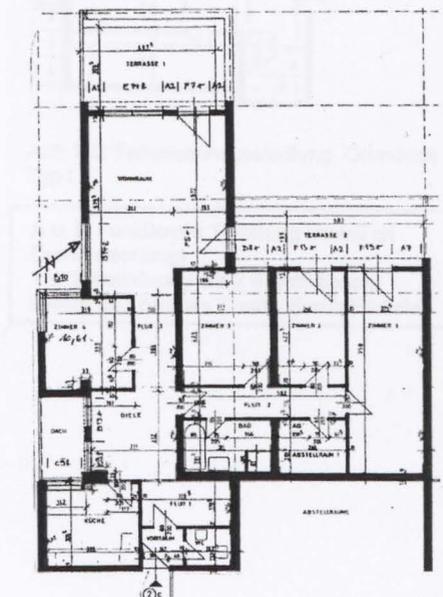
Terrassenhaussiedlung, Grundriss, Typ c
